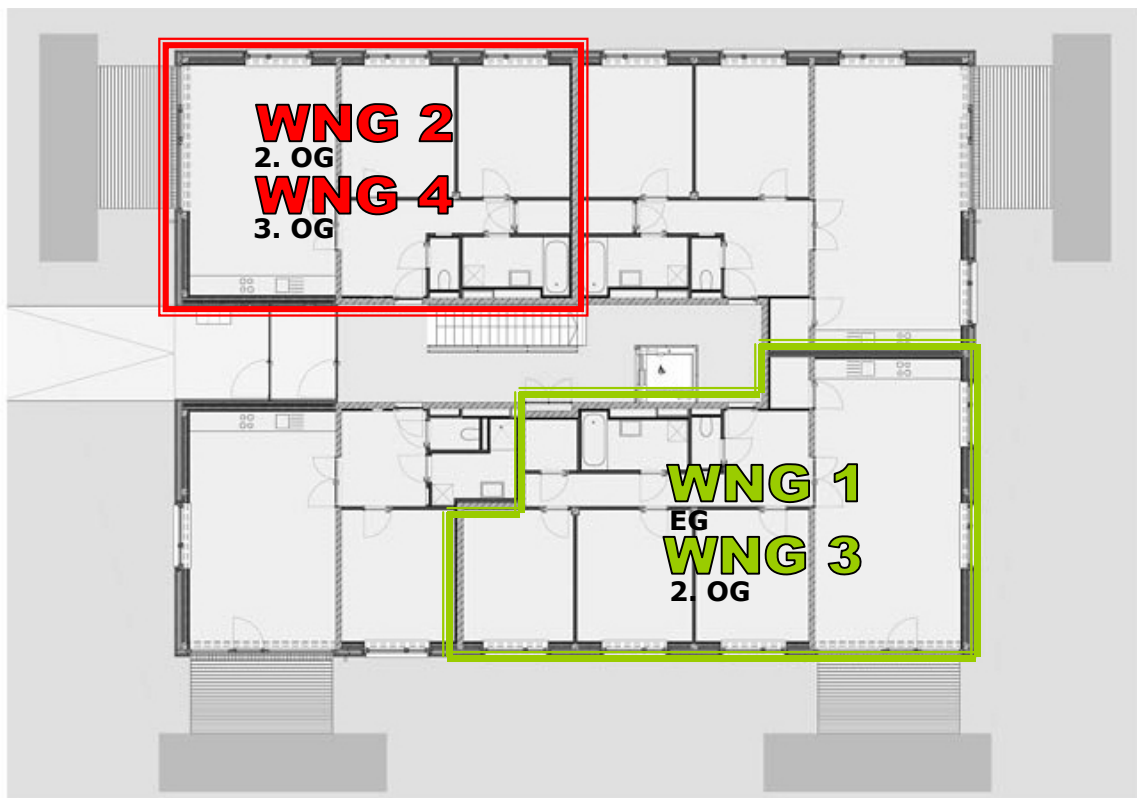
Grundriss Regelgeschoss Haus C
